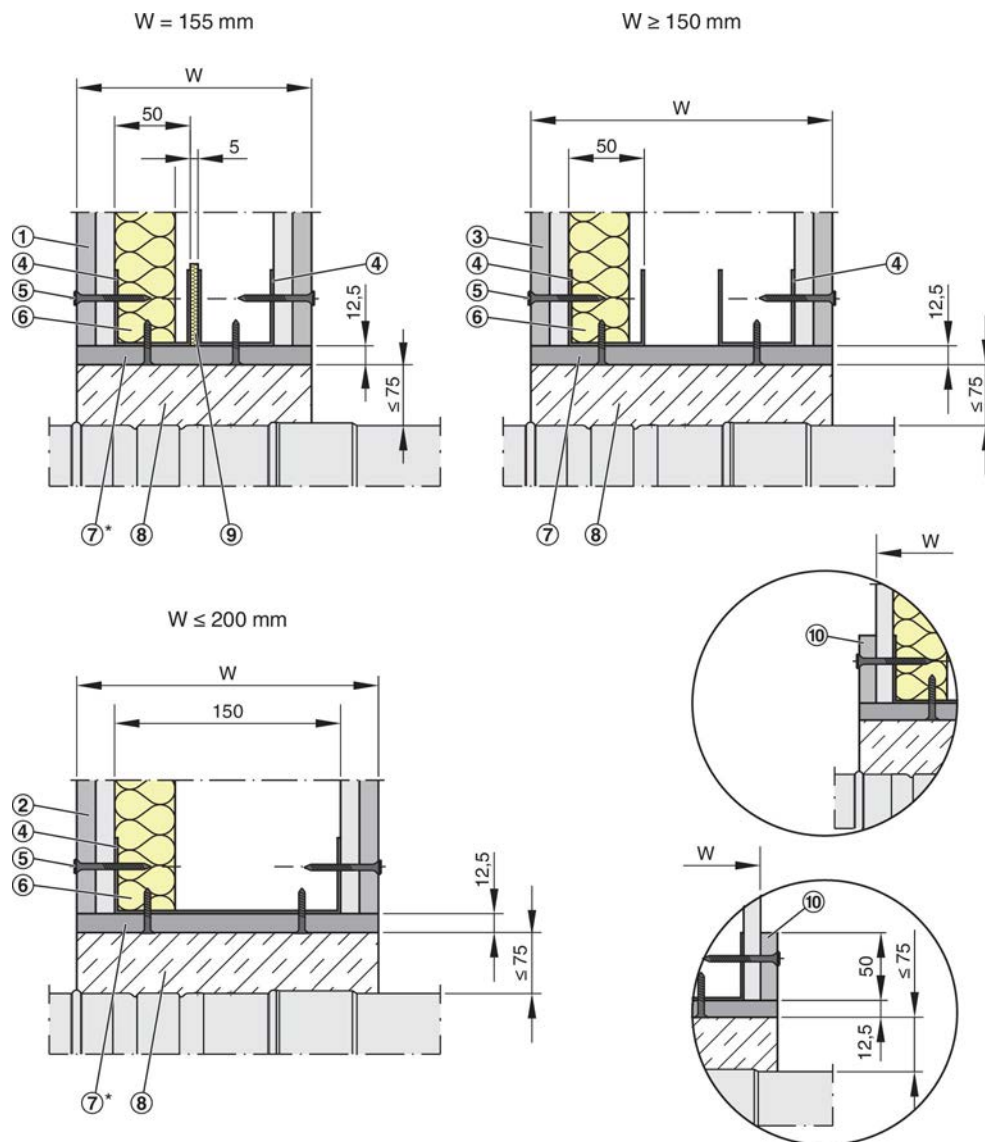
Instalación con mortero en paredes ligeras de sectorización, $W \geq 150$ mm
